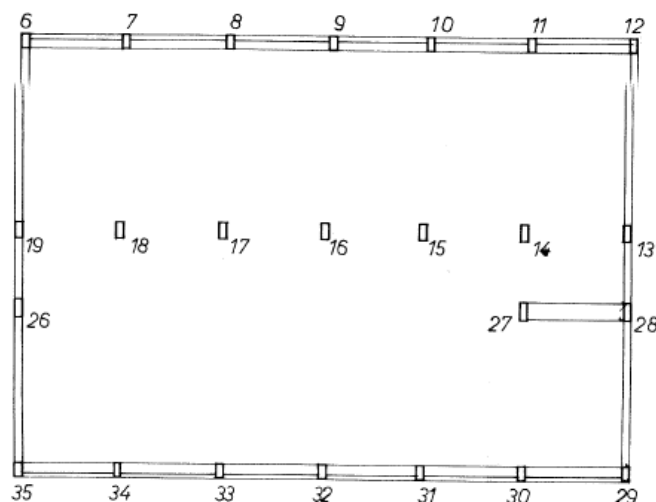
Pianta originale delle pareti e delle travi del seminterrato
